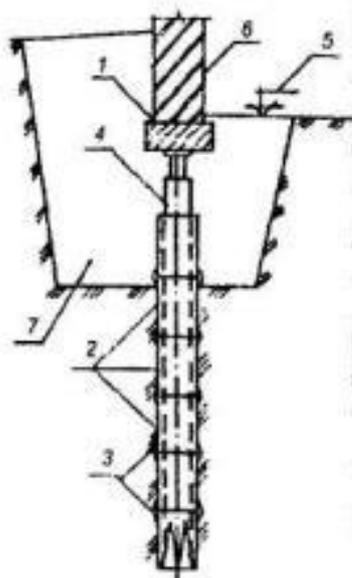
1 - подкладка; 2 - звенья из металлических труб длиной 50 см; 3 - сварка; 4 - гидравлический домкрат; 5 - отметка пола подвала; 6 - кирпичная стена; 7 - пазух, заполняемый фунтом с уплотнением после вдавливания свай.
